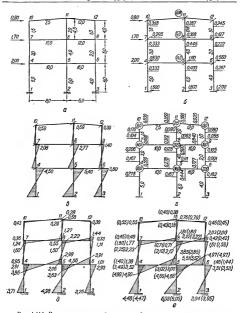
Расчет двудпролегиой трехутажной рамы на встровую нагрузку:
